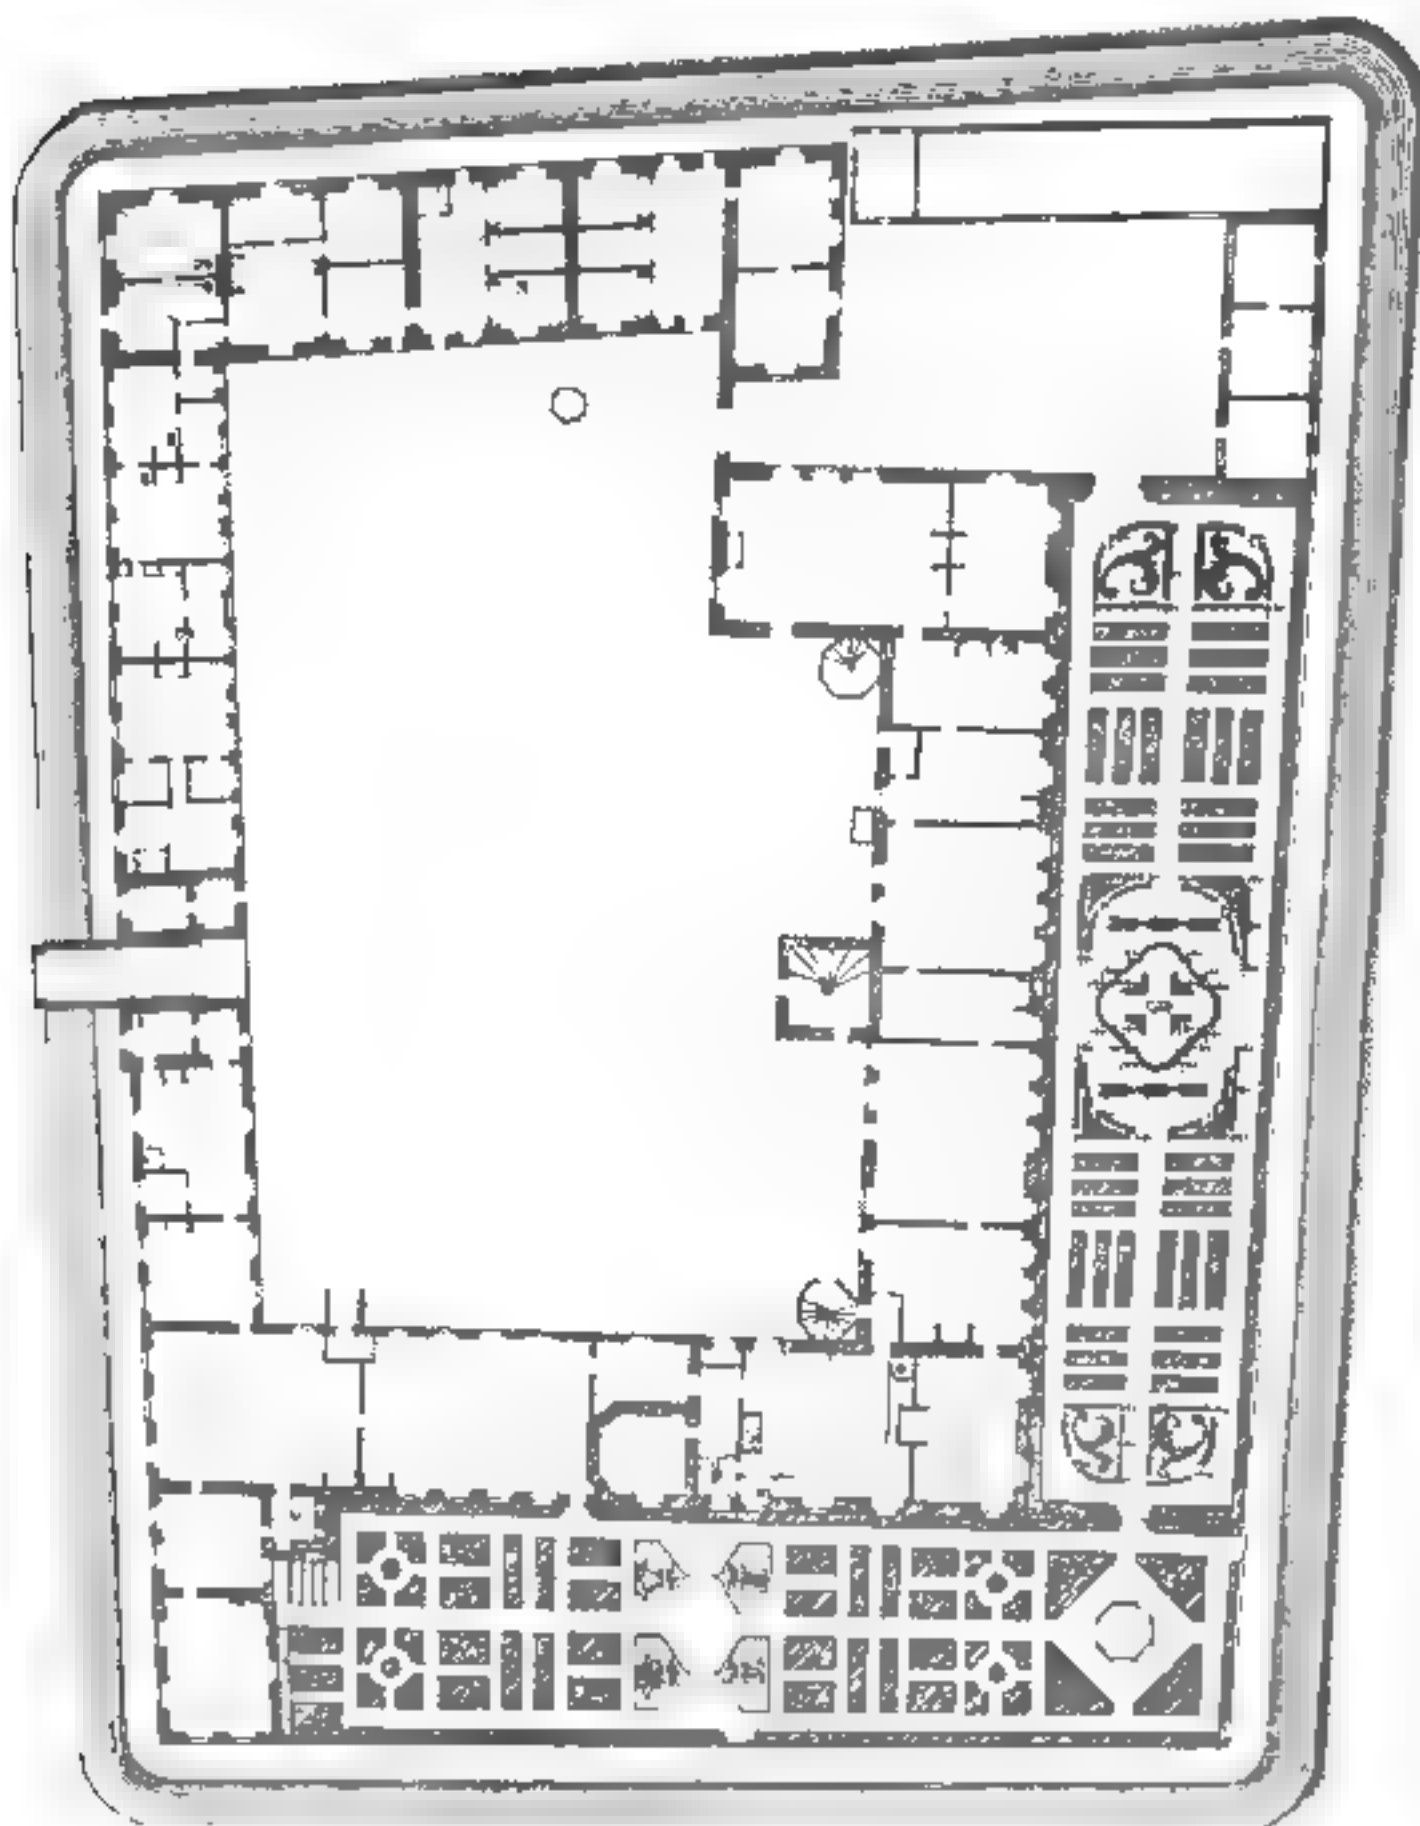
Grundriss des Schlosses mit den Hofbauten.
